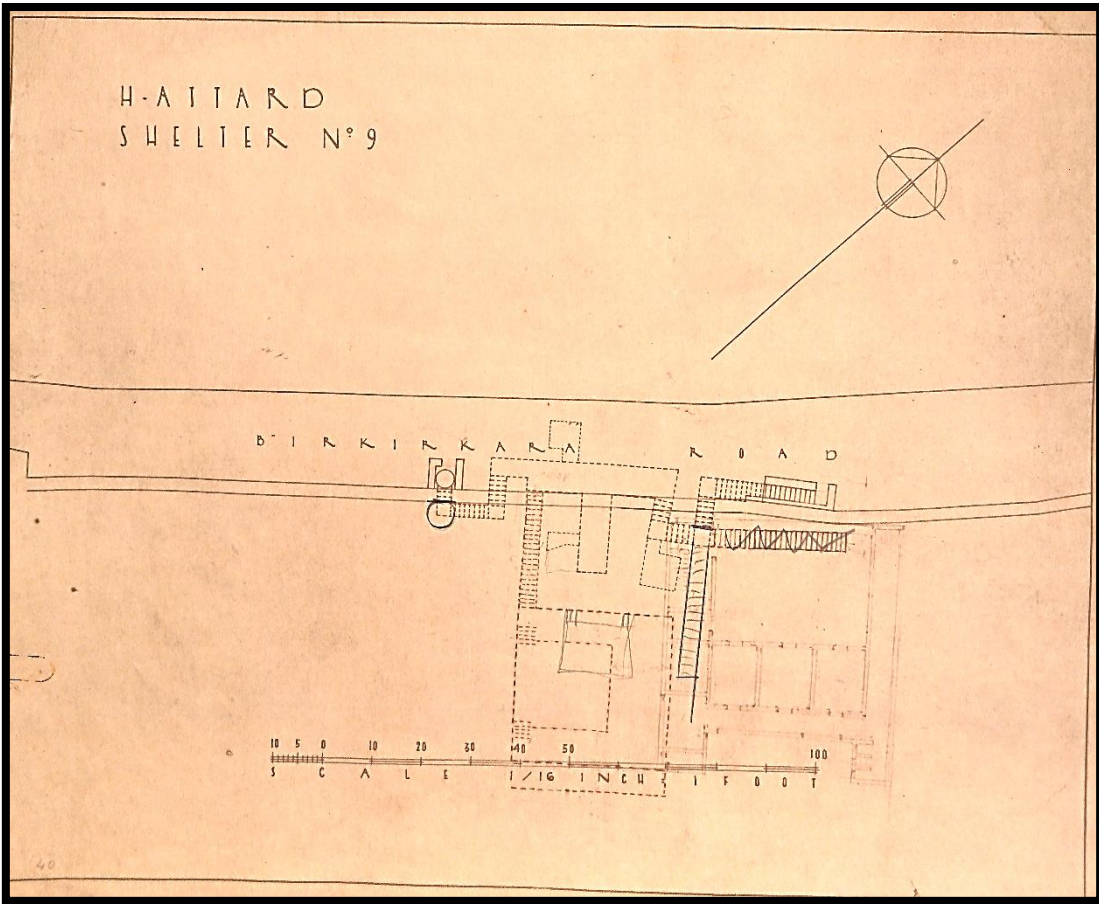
Planta do Abrigo nº9 "Birkikara Road"
